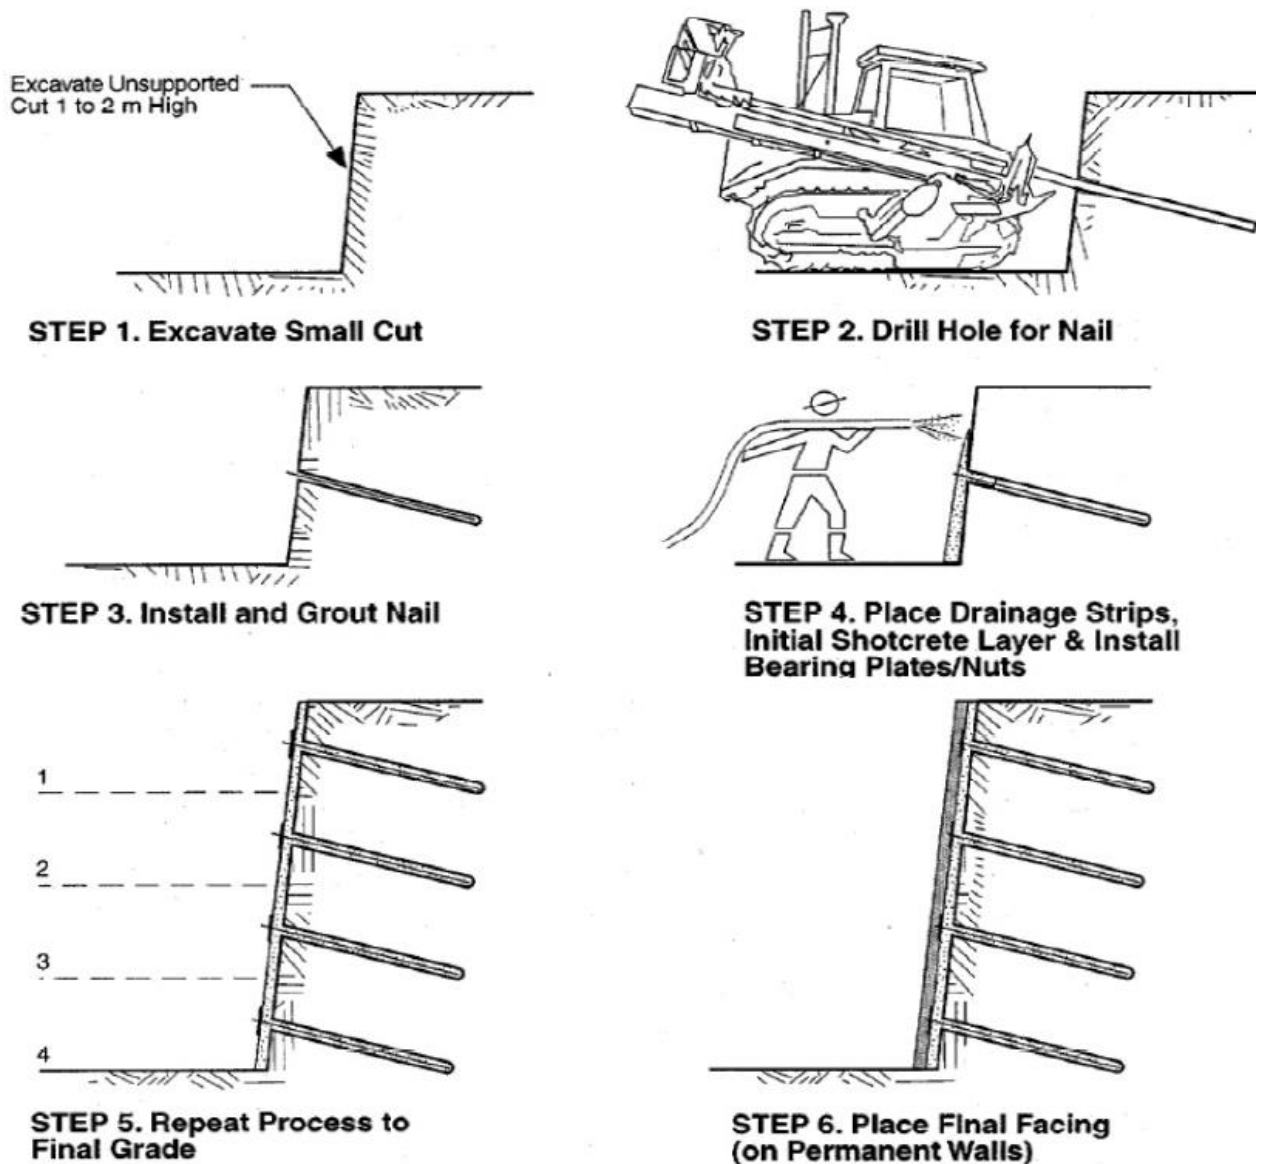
Procedimiento constructivo Soil Nailing. Dey (2014).
